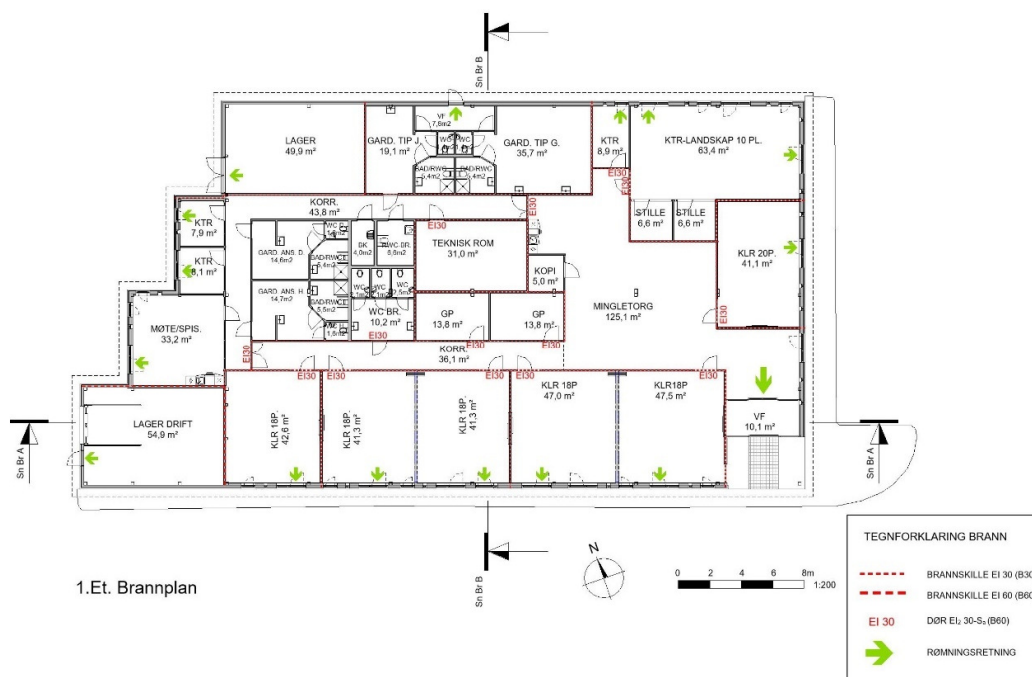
Brannsikring plan 1. et. BOARCH arkitekter a.s
